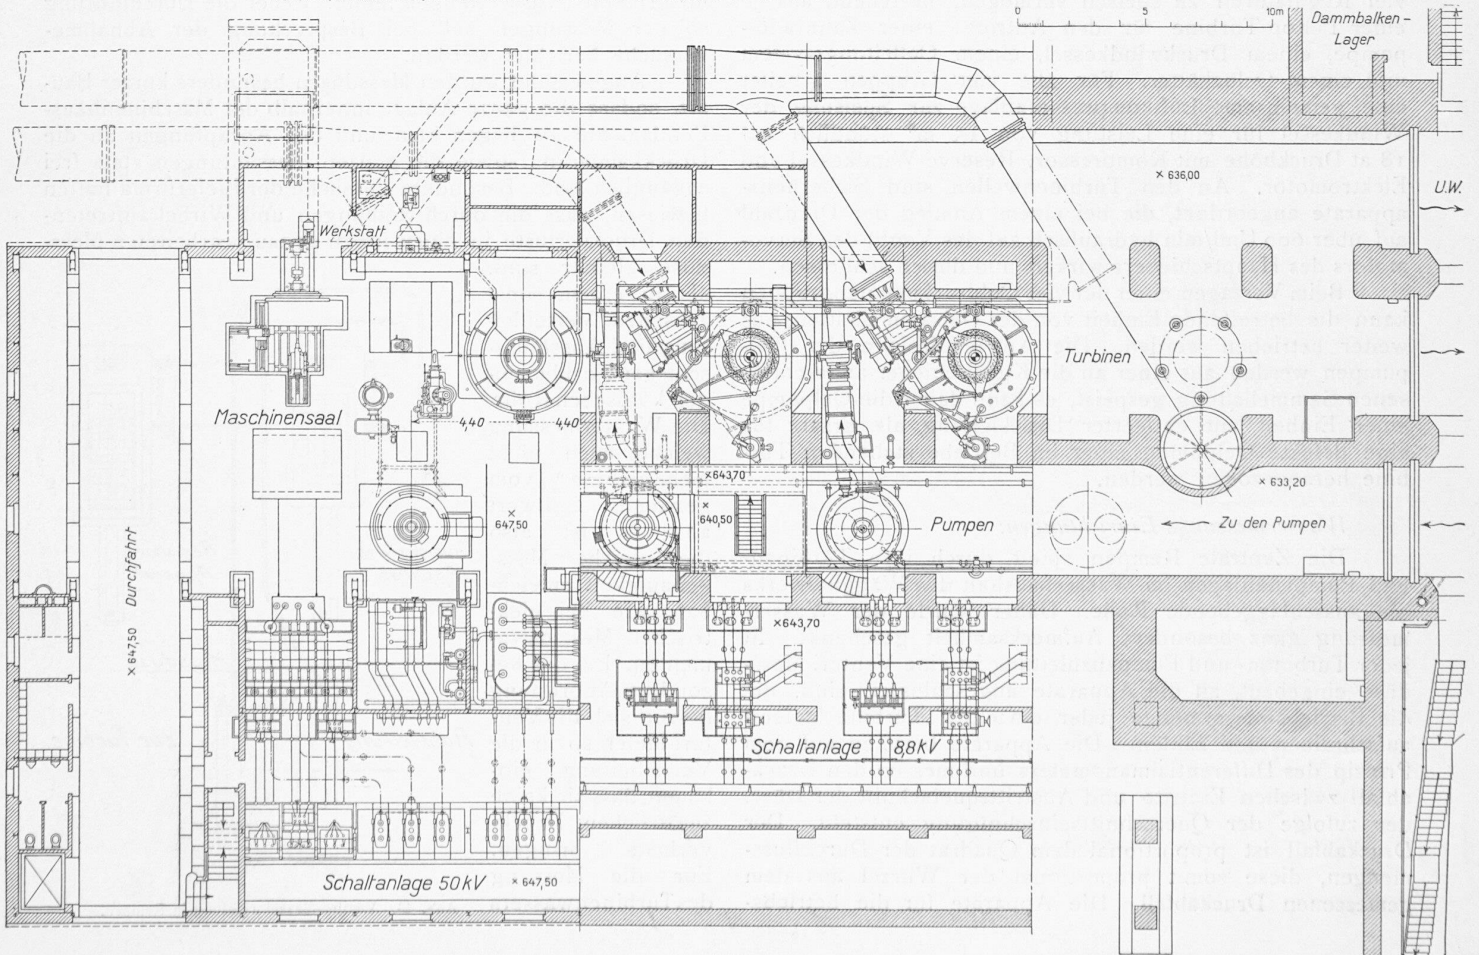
und 39. Grundrisse und Längsschnitte. — 1 : 275.
